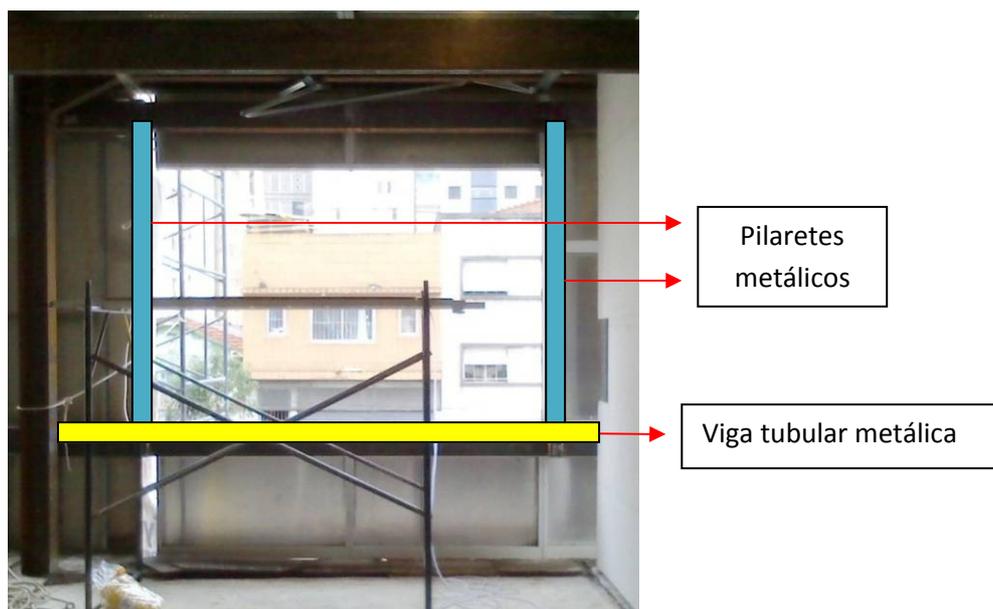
Vista interna do vão onde será instalado o guarda-corpo em vidro com os pilaretes de fixação
